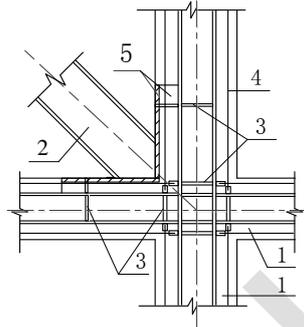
支撑与型钢混凝土组合结构梁柱节点域的连接构造
